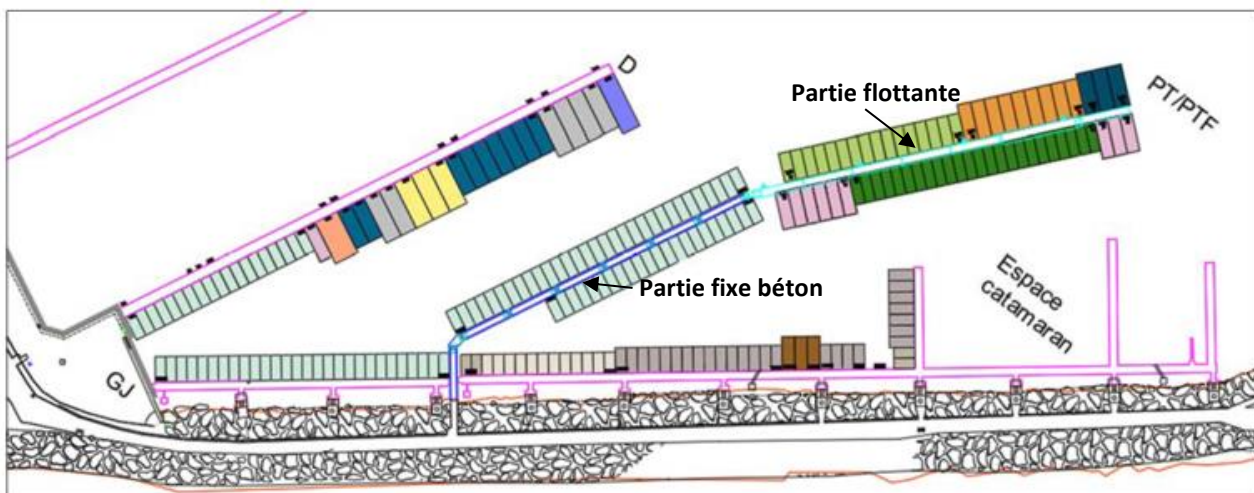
Vue en plan de la disposition de la panne touristique et plan de mouillage
